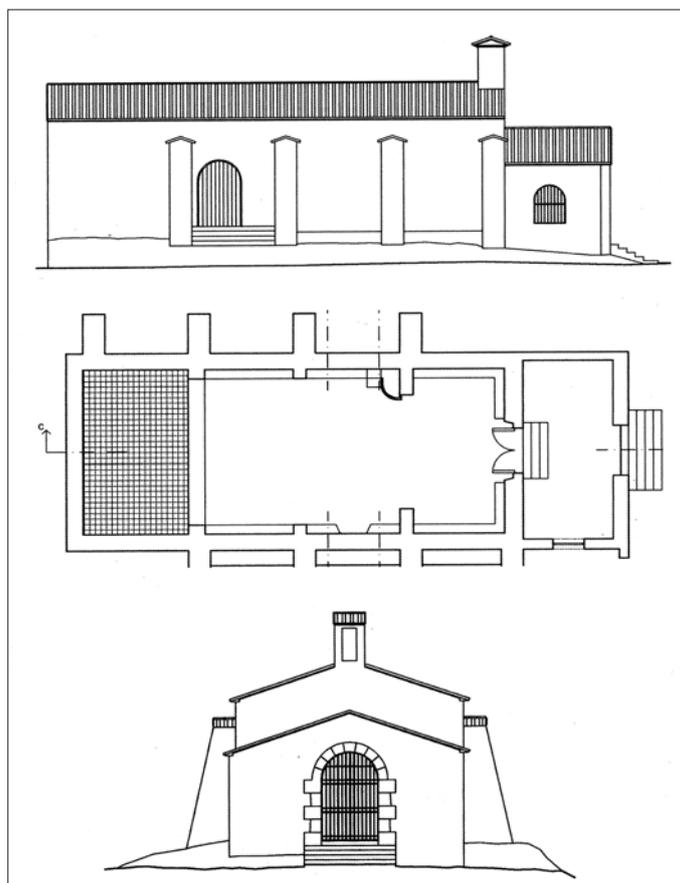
Planta y alzados de la Ermita de Santa Bárbara de Cocentaina (Fuente: Domenech Faus, 2003).
